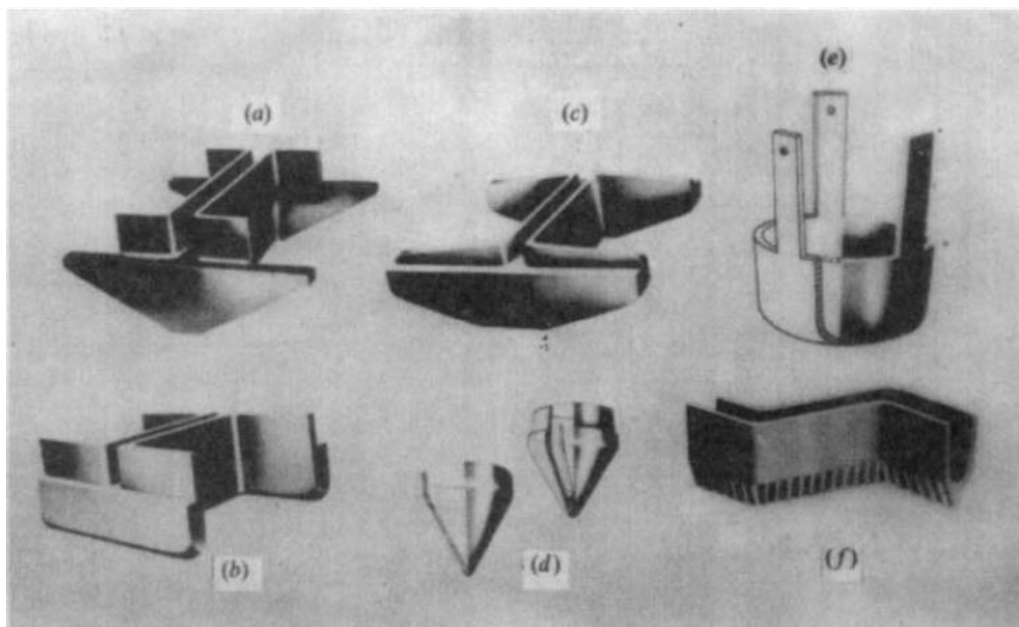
Piezas metálicas para la protección e incremento de la superficie de contacto de los perfiles metálicos. Fuente: (Bowles, 1997)
